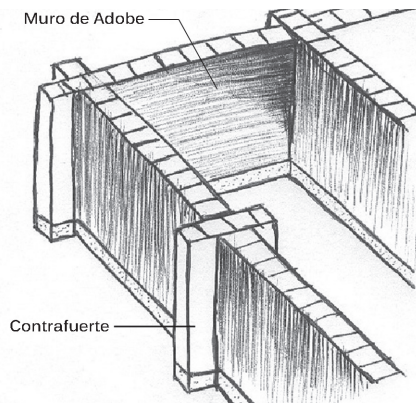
Detalle de contrafuertes de una pared de adobe
